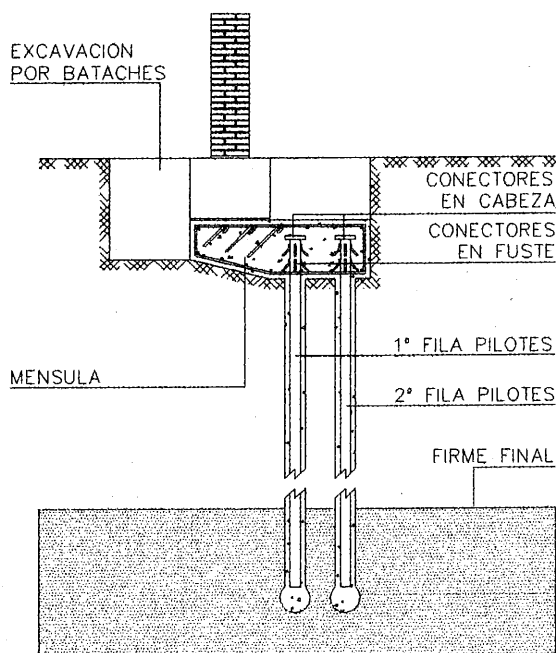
Recalce profundo: pilotes in situ con encepado en ménsula.
